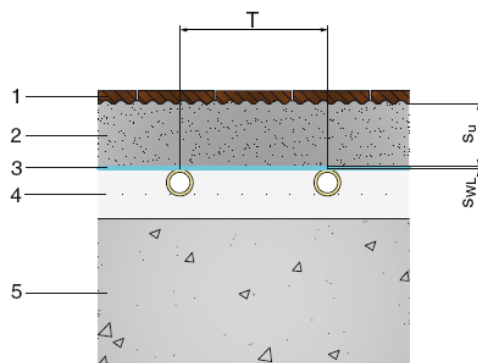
TIPOLOGIA DI PAVIMENTO
